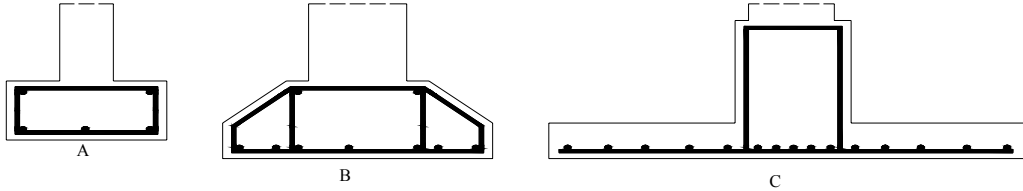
Izgara betonarme temelde kullanılan kirişin çelik donatısı (Ölçek: 1/20)
